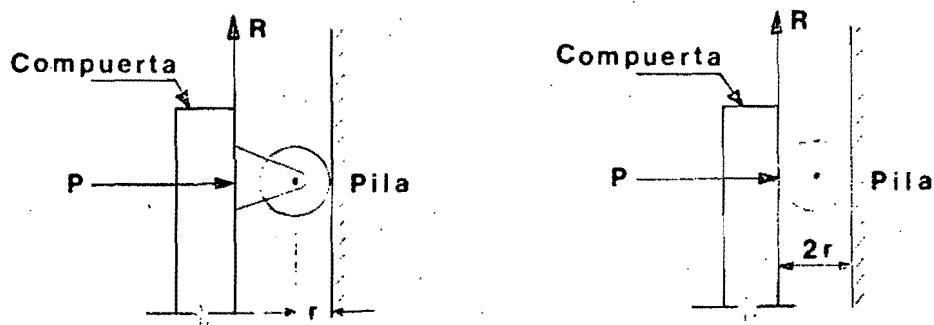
Rodillos unidos a la compuerta y entre compuerta y pila.
